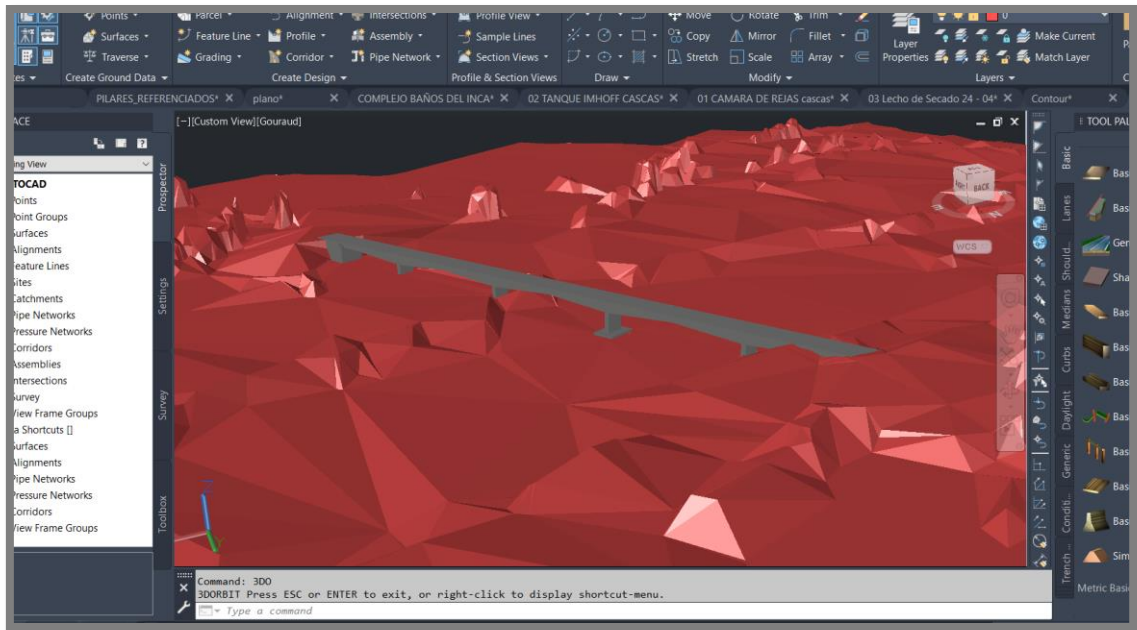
Formato tridimensional de la estructura del puente y el terreno del cauce del río moche
